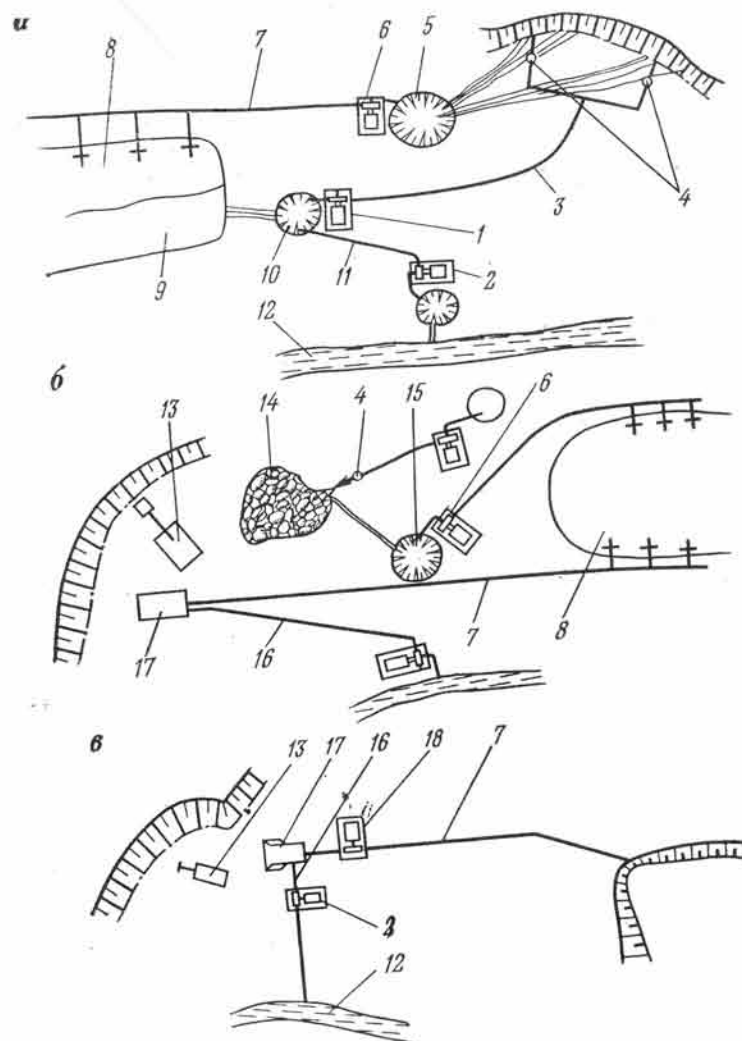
Схемы перемещения вскрышных пород в гидроотвалы с использованием гидротранспортных установок:
